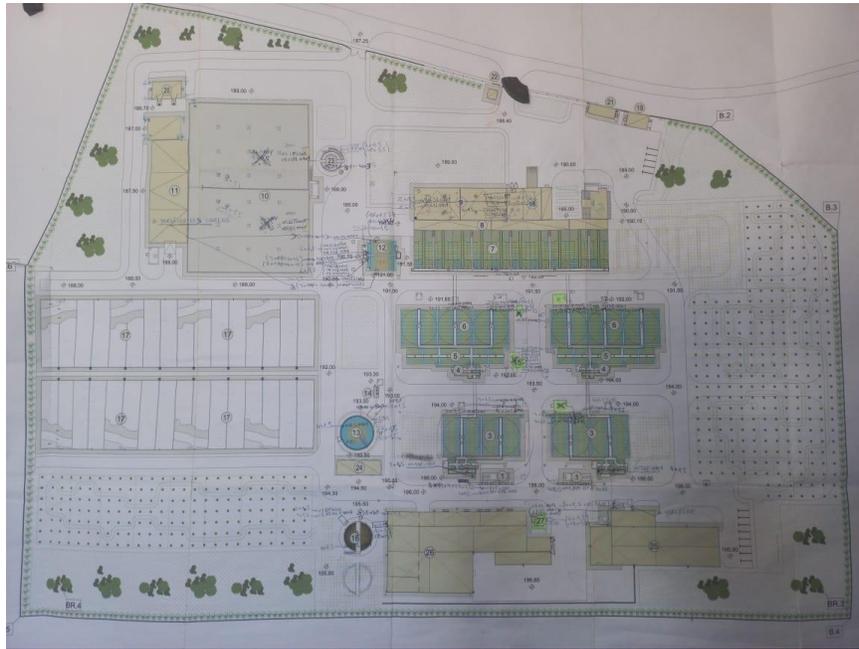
Plan d'exécution de site d'AEP – Taounate.
